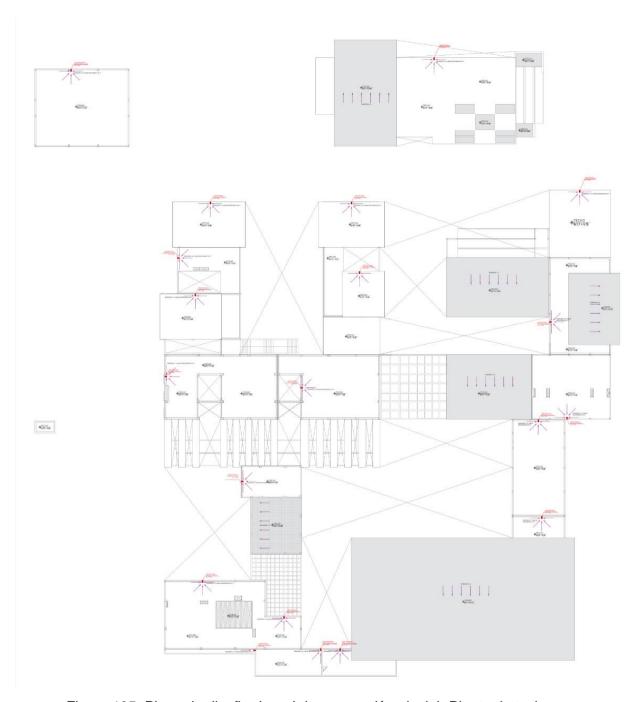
Plano de diseño de red de evacuación pluvial- Planta de techos.
